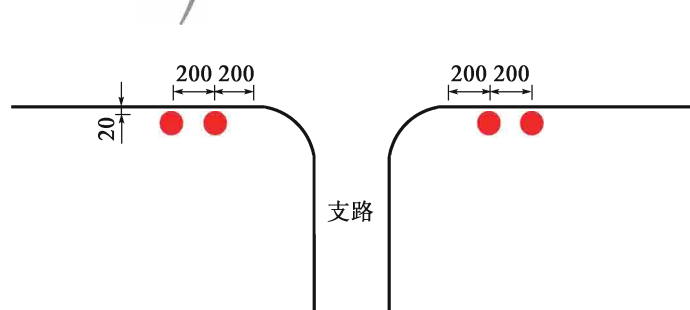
道口标柱设置示意(尺寸单位: cm)
